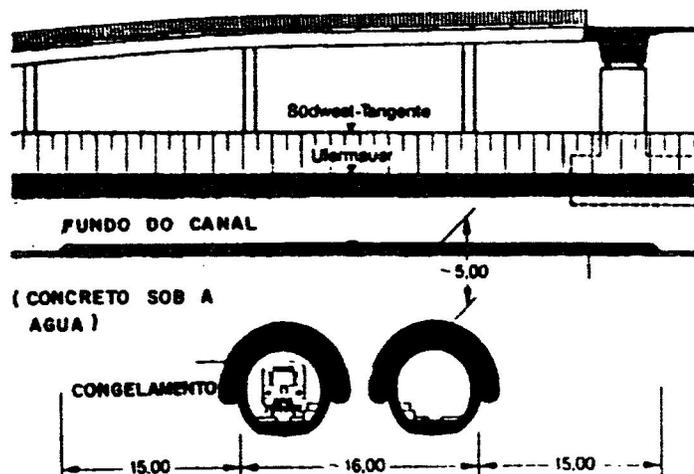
Corte Transversal sob o Canal de Main - Donau
